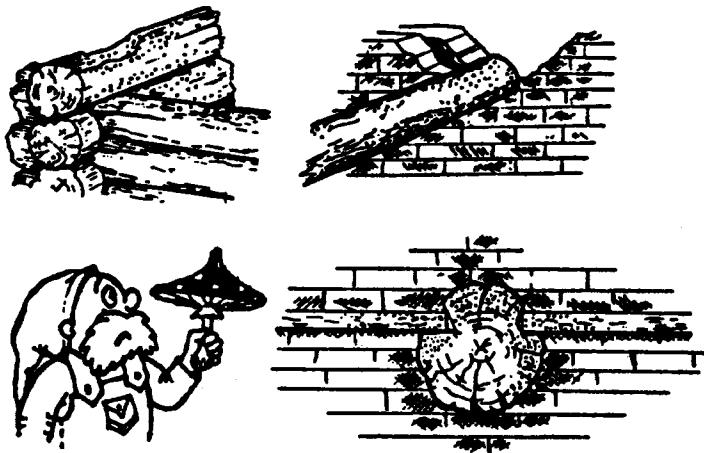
Элементы конструкций домов, подверженные разрушению насекомыми и грибами в первую очередь
